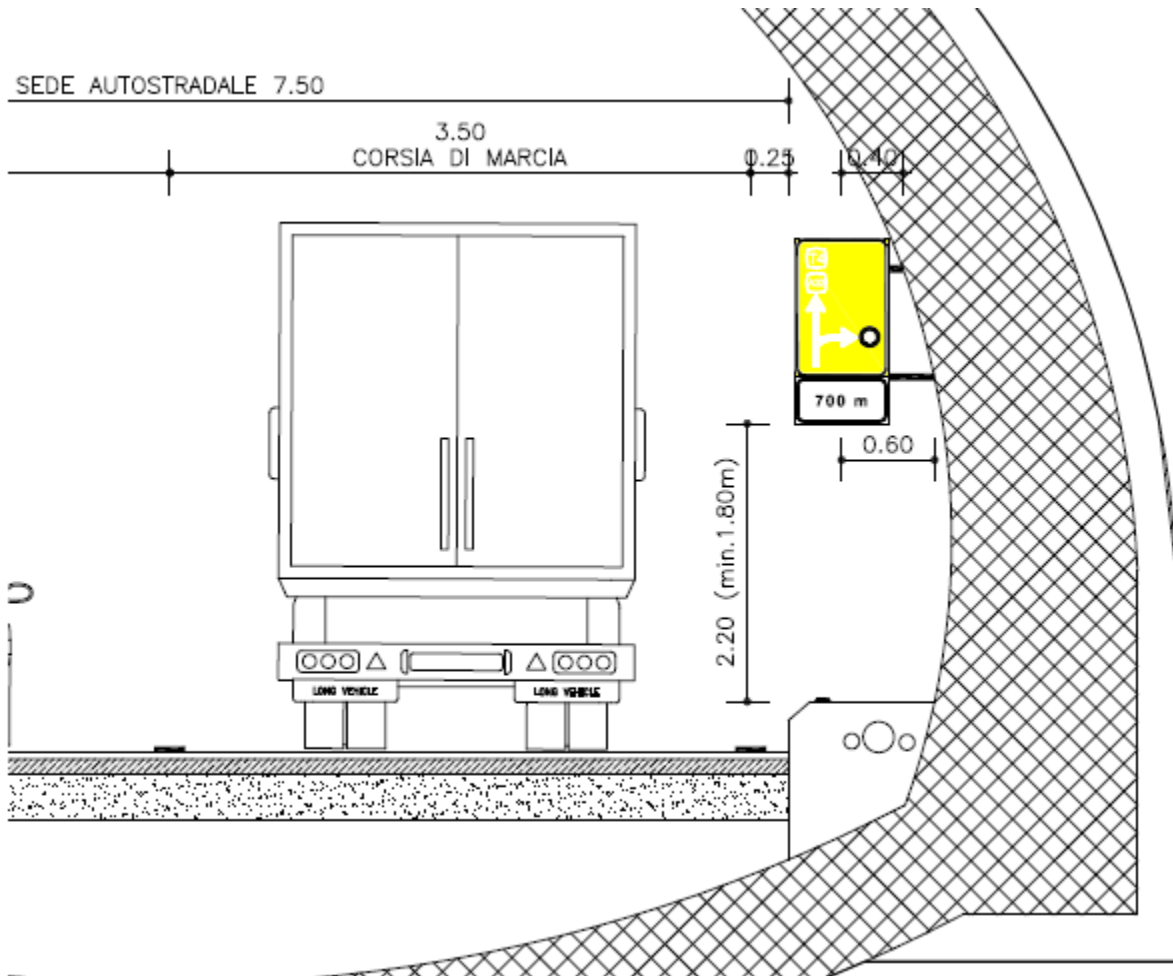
Cartello Rettangolare su piedritto galleria – Geometria
